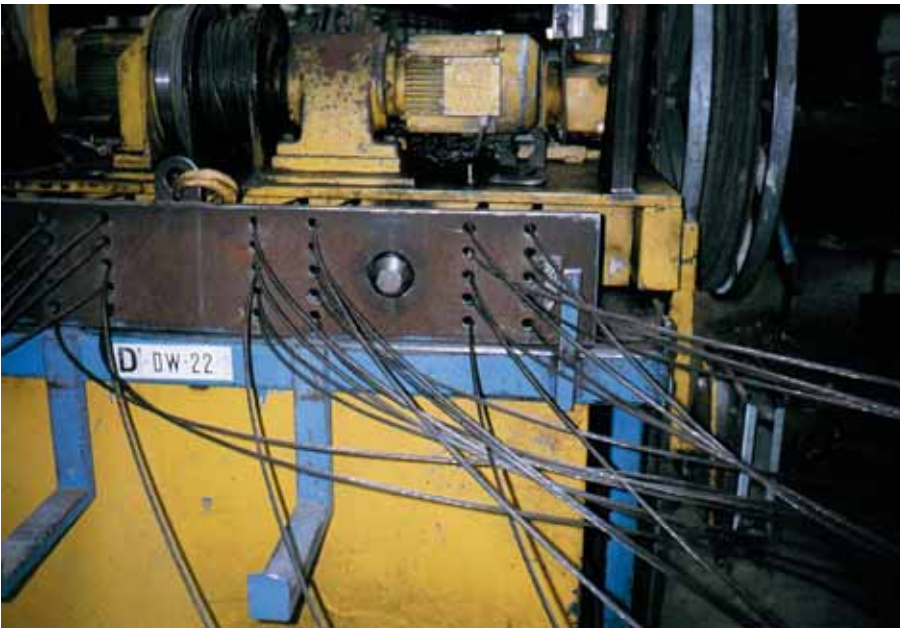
Aan de strengentrekkar zit een sjabloon, waarin de streng wordt gestoken. Achter de machine bevinden zich vier kopschotten, die aan het eind van de baan in de bestemde sleuven worden geschoven. De strengen zijn eerder al door het kopschot gestoken en de verankeringswig is aangebracht en vastgezet
